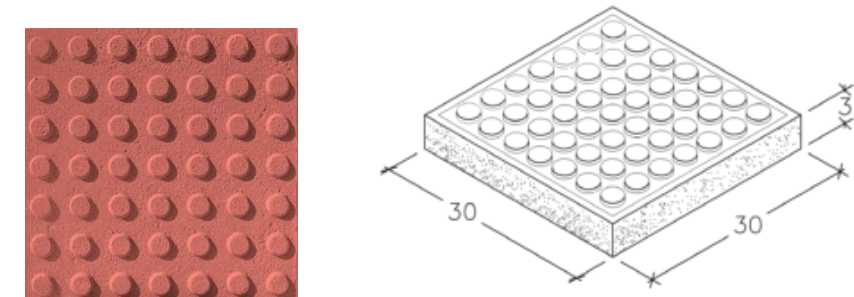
1 Baldosa hidráulica de hormigón de 49 botones cilíndricos. Fuente: Publicidad de Pretensados Campo.
